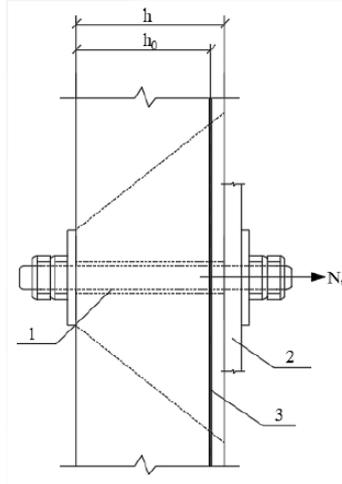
附着螺栓孔处混凝土受冲切状况图
